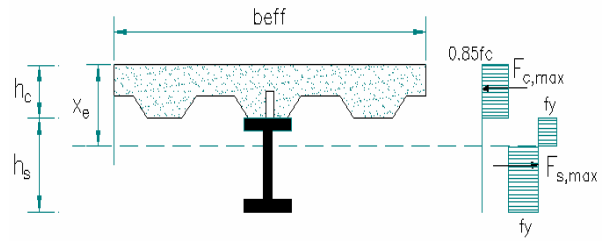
Distribución de esfuerzos plásticos con eje centoidal en la viga de acero
